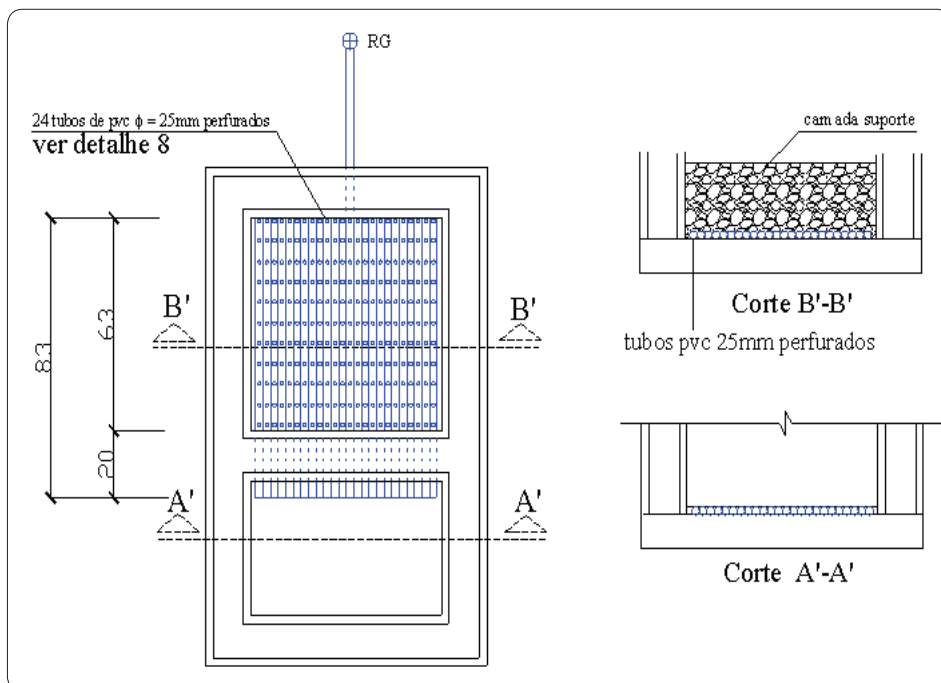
Planta baixa no nível 0,1 m (cotas em cm).
